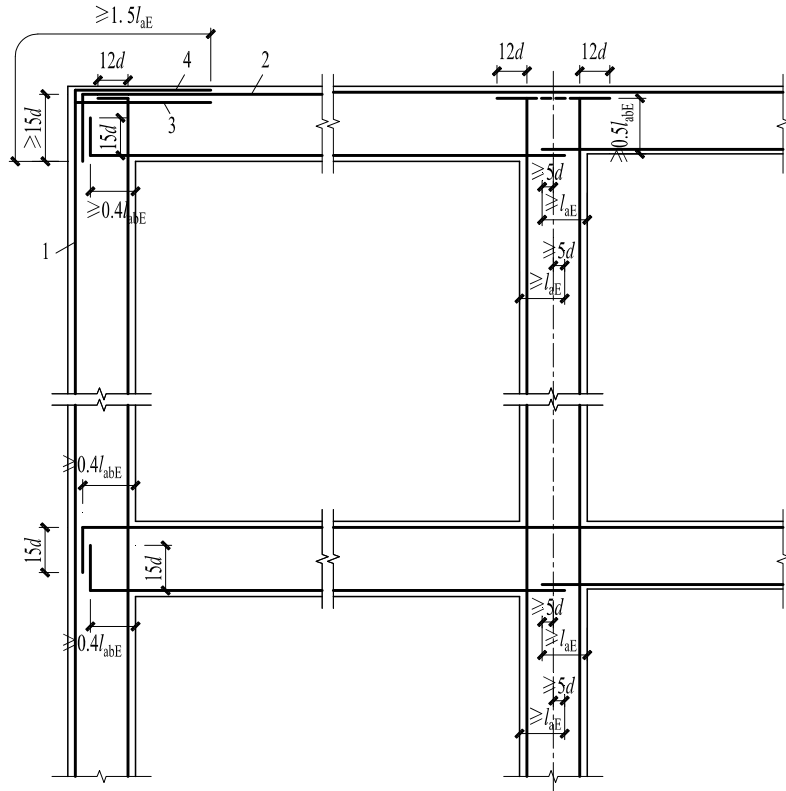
抗震设计时框架梁、柱纵向钢筋在节点区的锚固要求
